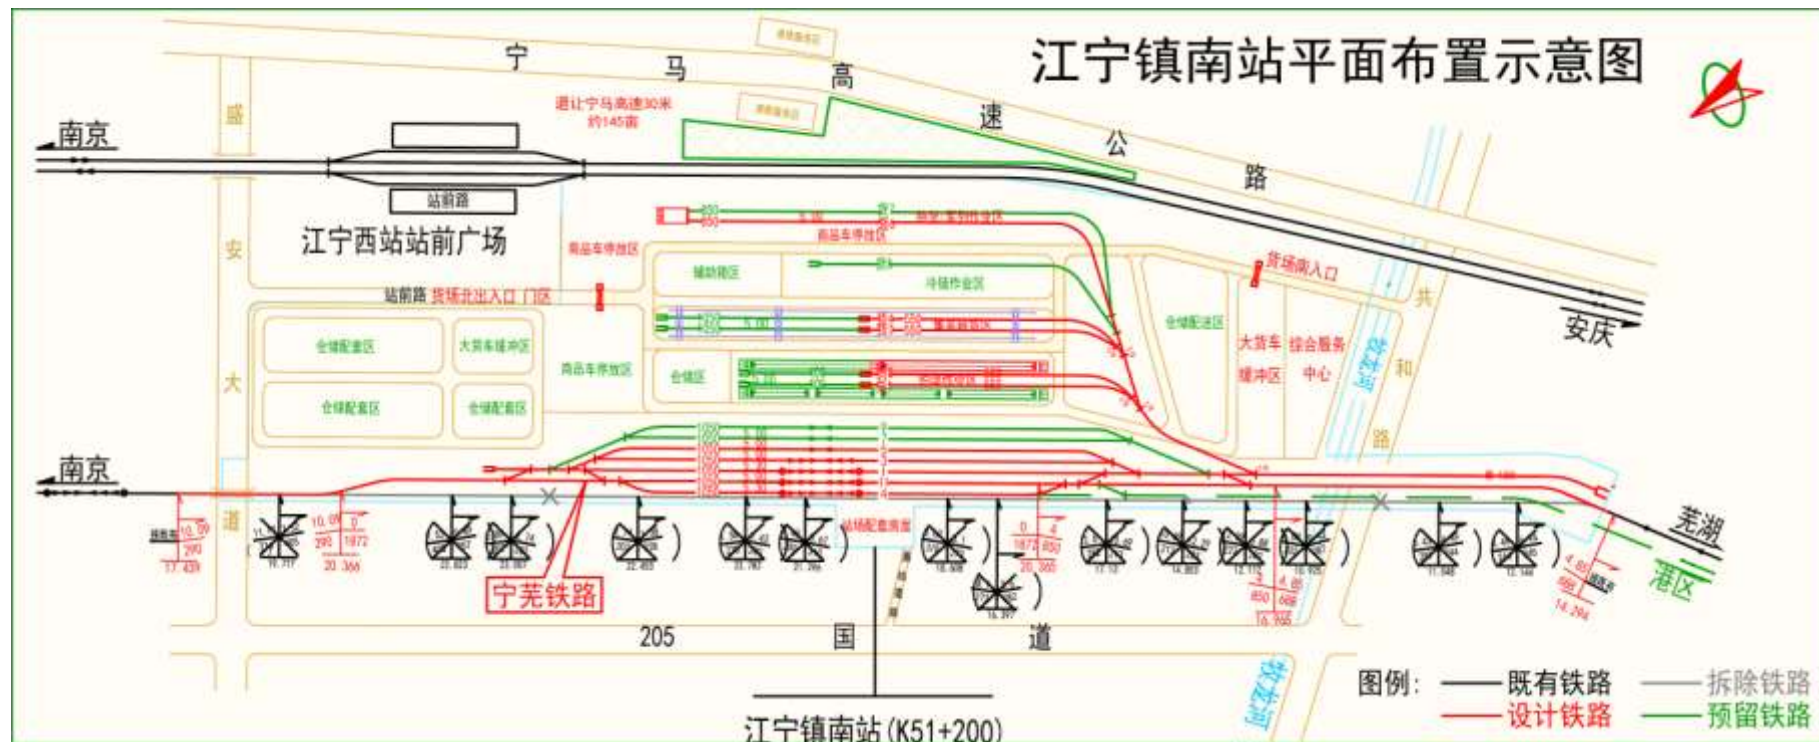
新建江宁区南站（含货场）平面布置示意图
